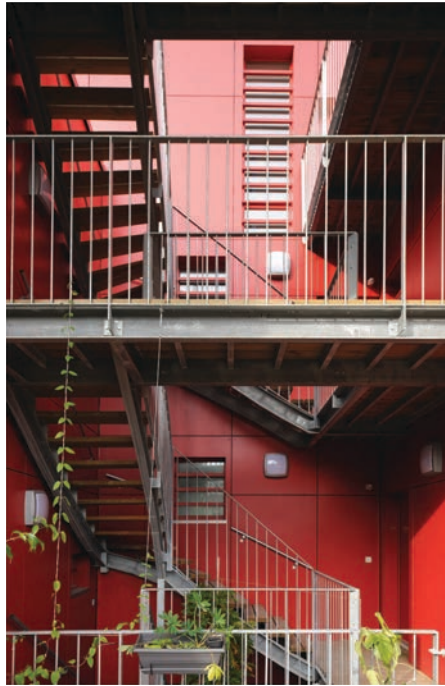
Photo de la montée centrale d'escalier de « la Salière », crédit photo : « la Salière ».
